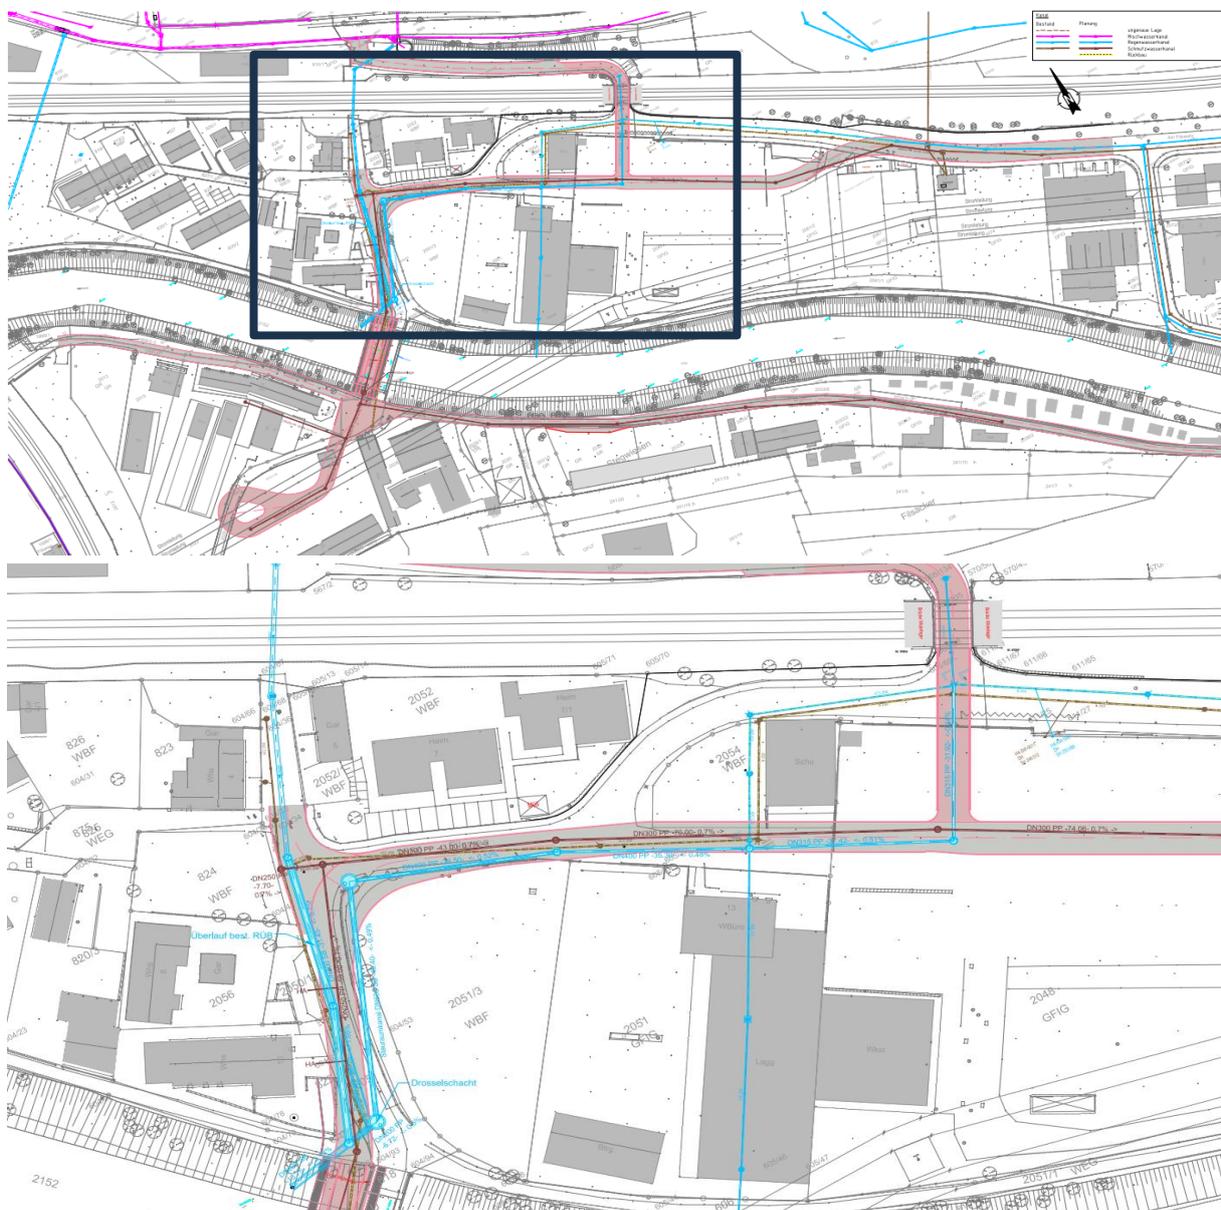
Lageplan Kanal mit Auszug BNP Ingenieure GmbH
